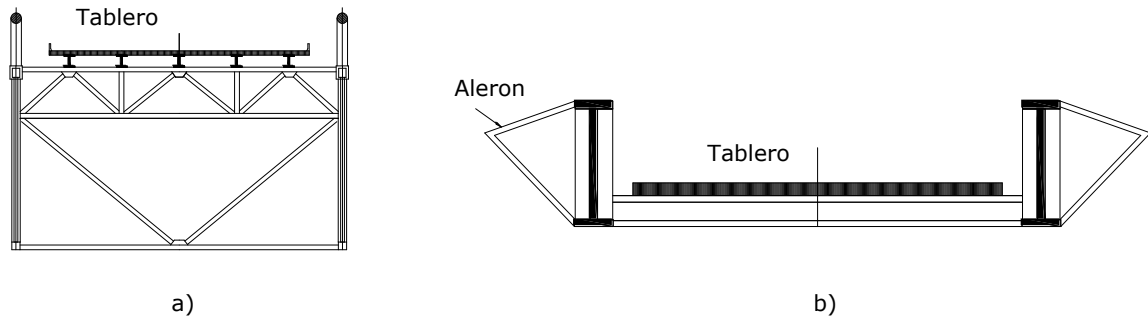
Tableros de puentes colgantes, a) Viga reticulada, b) Vigas I con estabilizadores aerodinámicos
